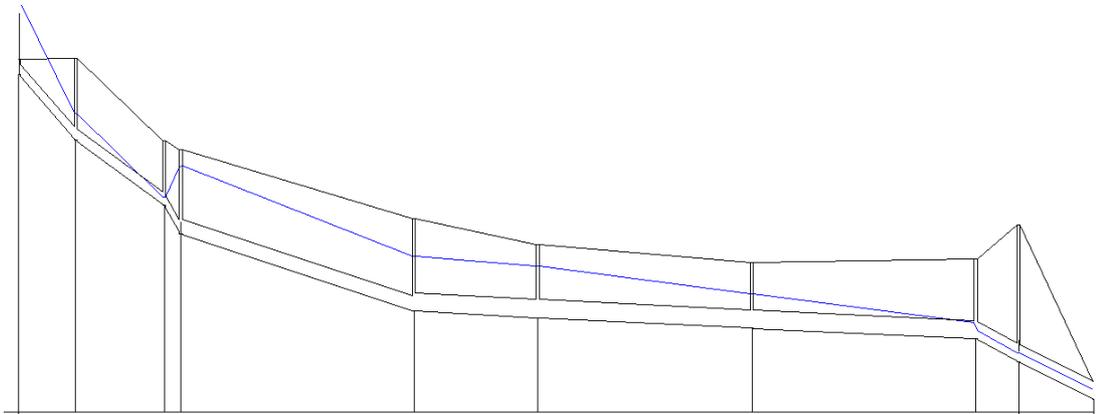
Hydraulischer Längsschnitt Bestandsberechnung mit einem 2-jährigen Modellregen, Kovacic Ingenieure (2021)
